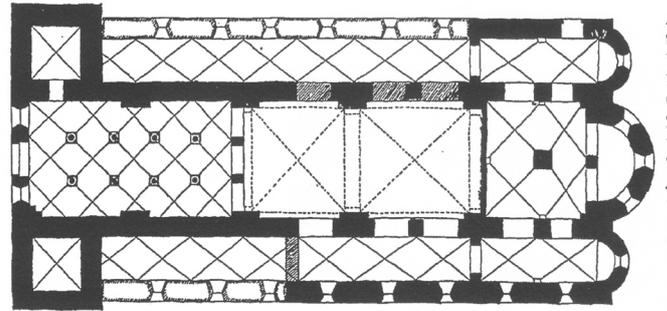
Germerode, Klosterkirche, Grundrissrekonstruktion nach Ganßauge, *Klosterschule*, 8.
